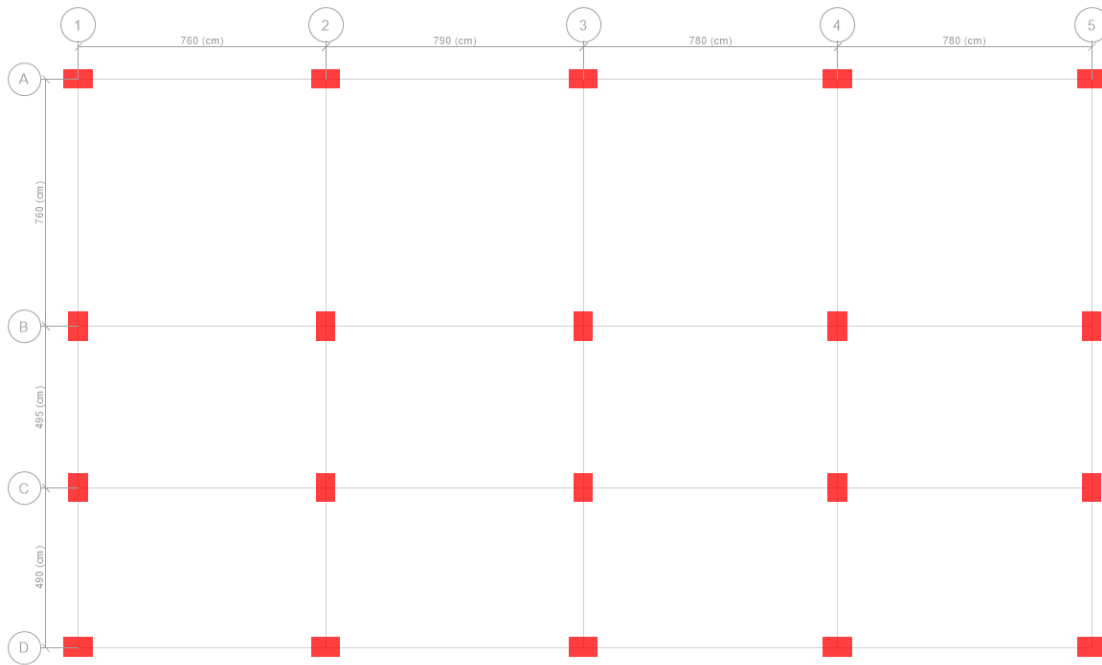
Vista en planta de columnas para el caso de estudio 1 - Etabs
